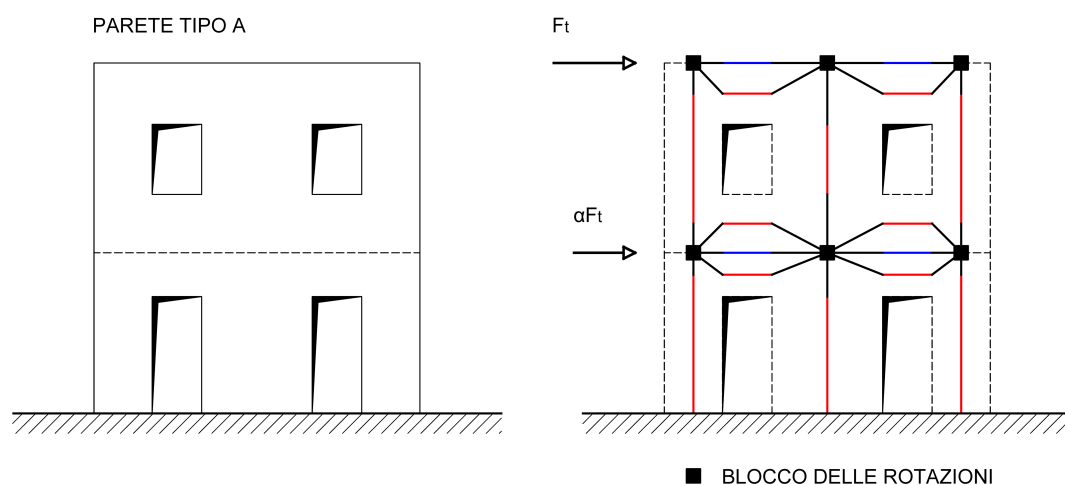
Idealizzazione in telaio "shear-type" della parete di tipo A della struttura benchmark n°5.
